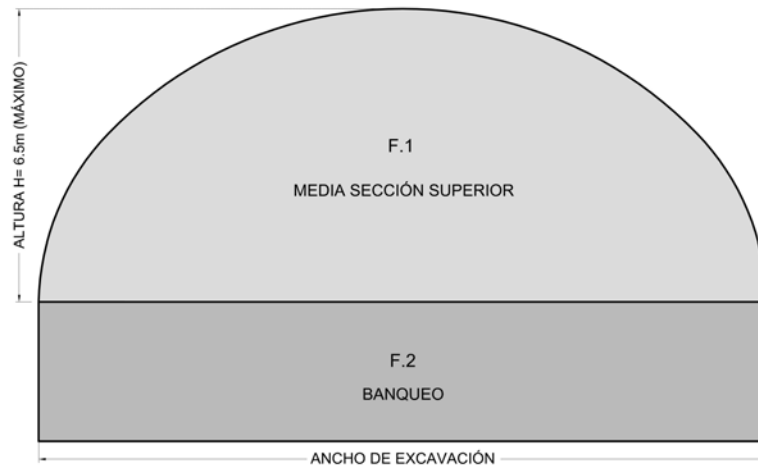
Excavación en dos fases (Media Sección Superior y Banqueo).
